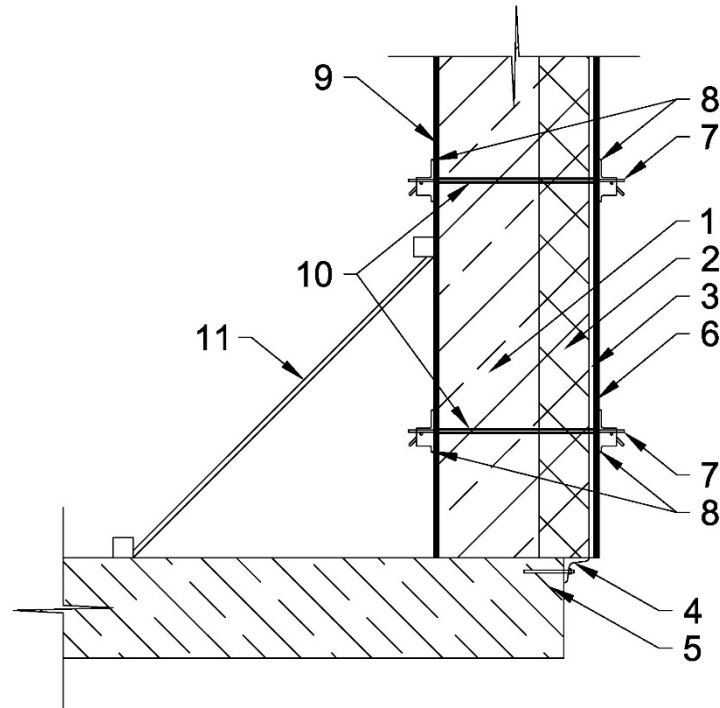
Схема улаштування теплоізоляційної стіни (після монтажу всіх елементів та укладання пінополістиролбетону): 1 – основний масив стіни з пінополістиролбетону; 2 – утеплювач; 3 – зовнішній огороджуючий шар; 4 – опорний кутик; 5 – плита перекриття; 6 – зовнішня опалубна панель; 7 – стяжка; 8 – пружинний затискач; 9 – внутрішня опалубна панель; 10 – трубка; 11 – підкос
